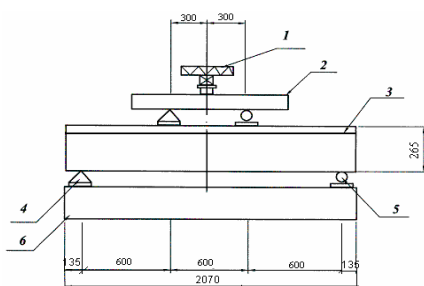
Схема установки для випробування балок на згин: 1 - плита-траверса преса; 2 - траверса; 3 - дослідна балка; 4 - нерухома опора; 5 - рухома опора; 6 - нижня траверса преса
